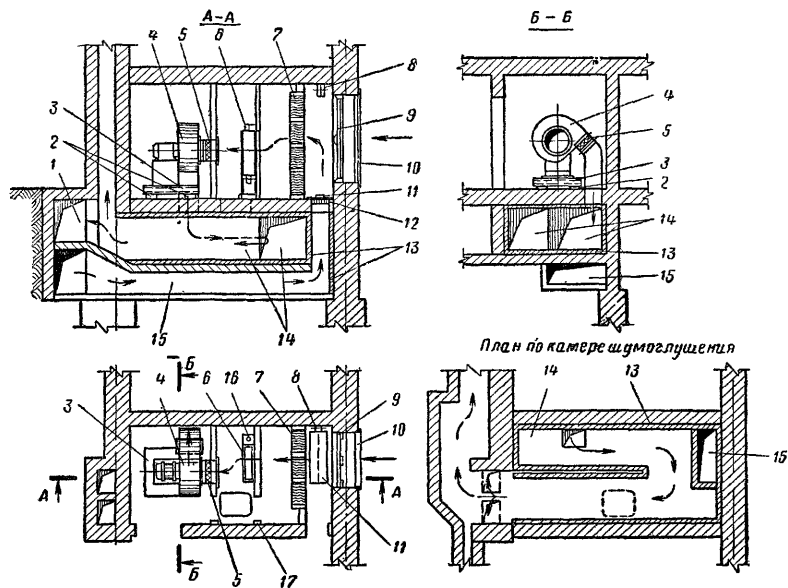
Приточная камера, размещенная на первом этаже здания
